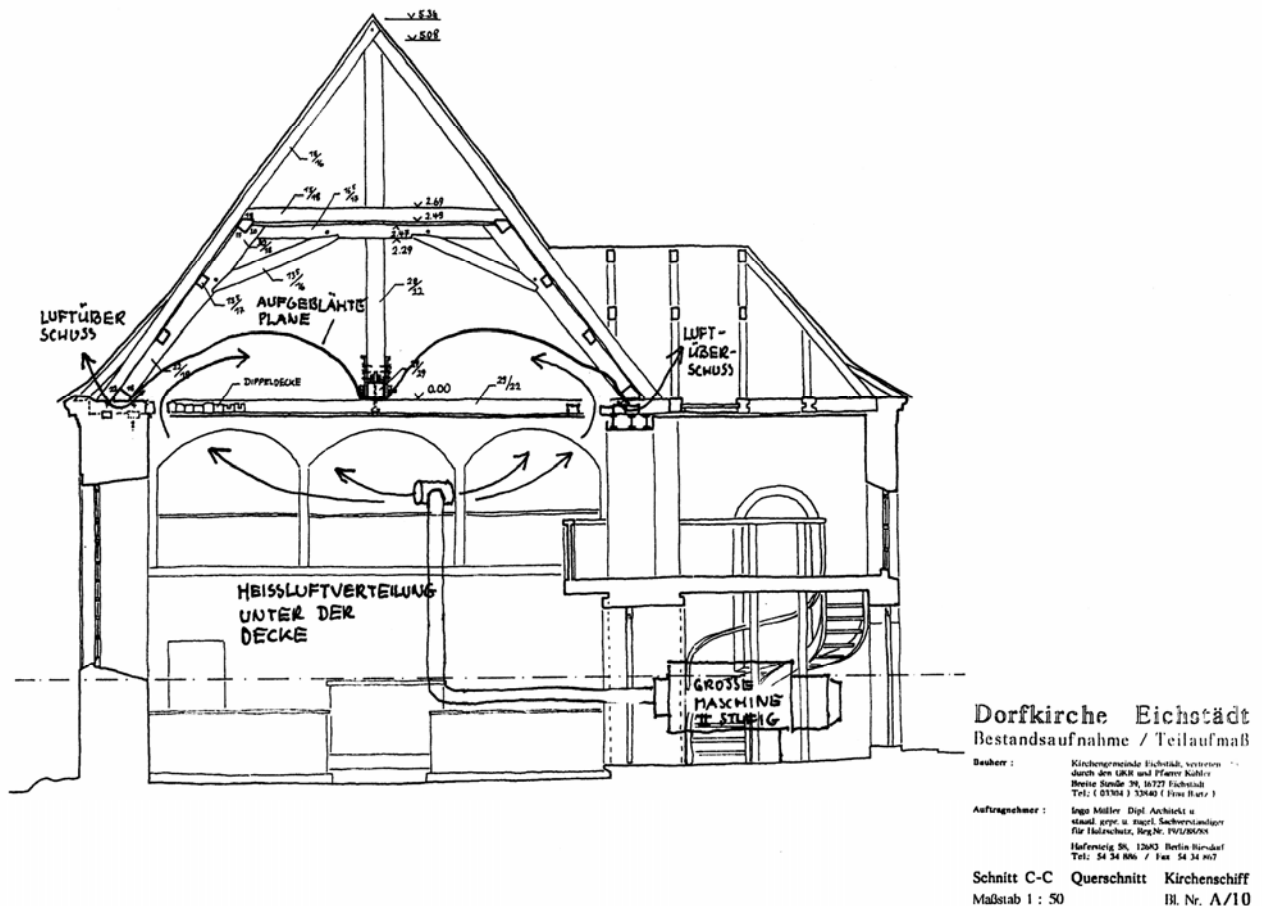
Kirchenschiff und Dachgeschoß im Querschnitt mit Darstellung der Heißluftzuführung und -verteilung.
